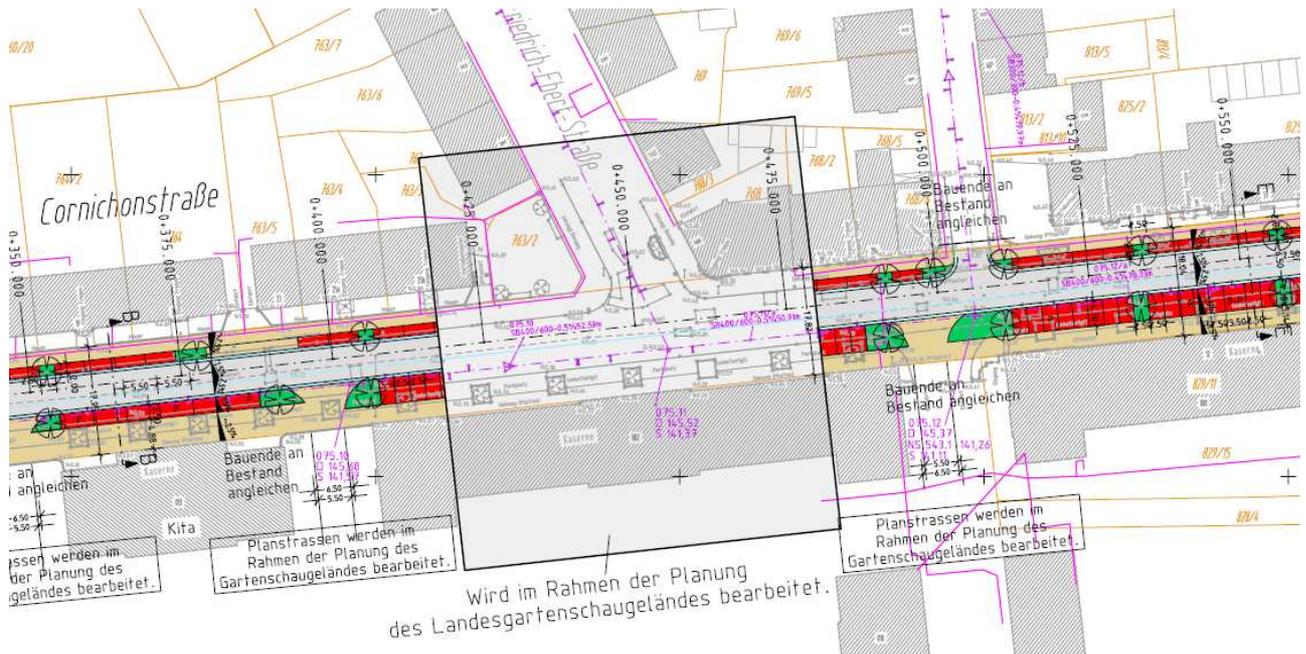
ipr Consult, Wiesenstraße 58, 67433 Neustadt: Ausschnitt aus der Entwurfsplanung zur Sanierung der Cornichonstraße, 16.09.2010
